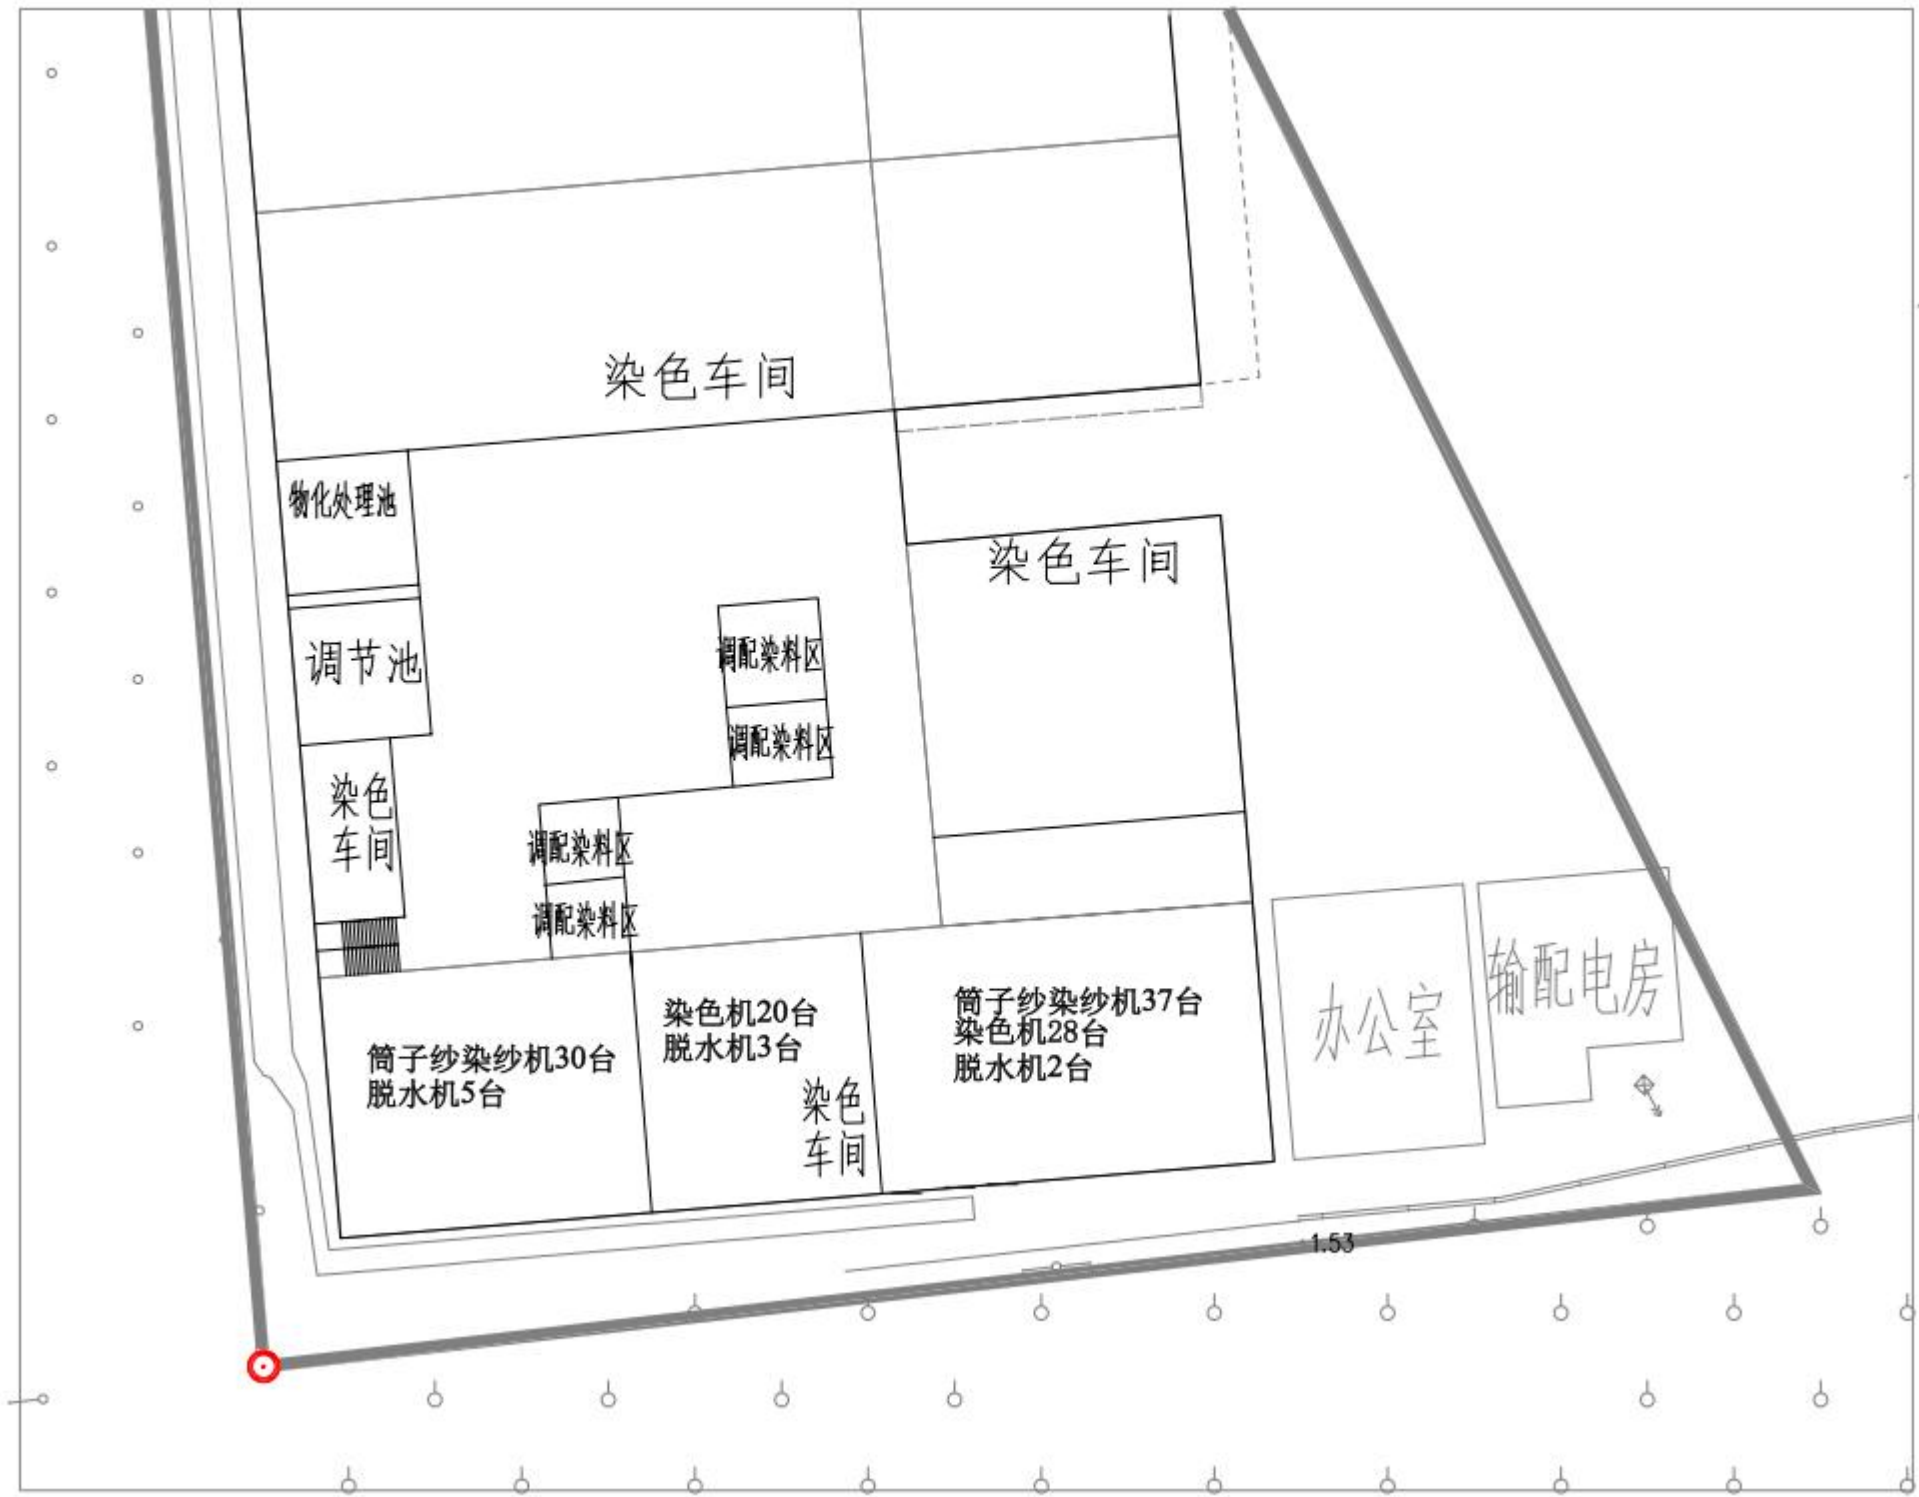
项目一层平面布置图-2（比例尺 1： 600）
